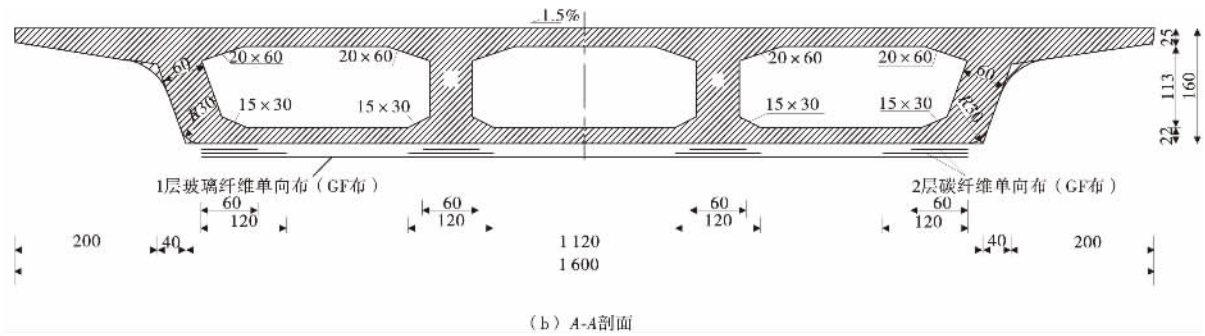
预应力混凝土简支箱梁底板混凝土强度等级不足的 FRP 抗弯补强结构形式
